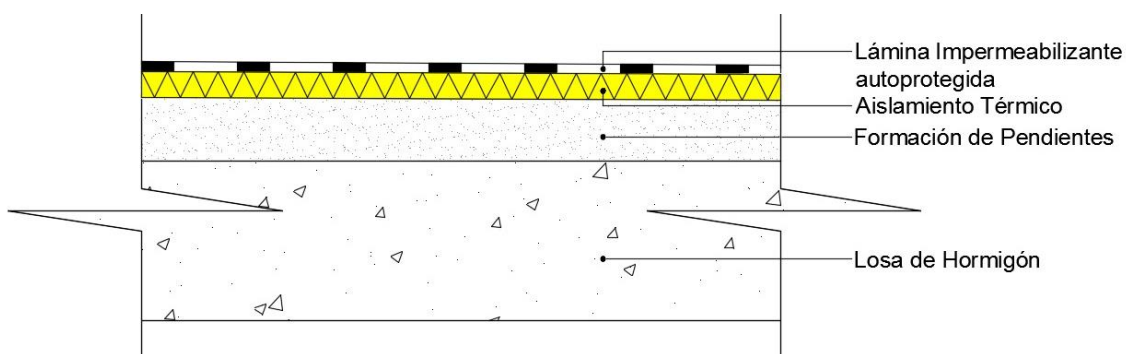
Sección constructiva del cerramiento del casetón de la cubierta con la introducción de la capa de aislamiento
